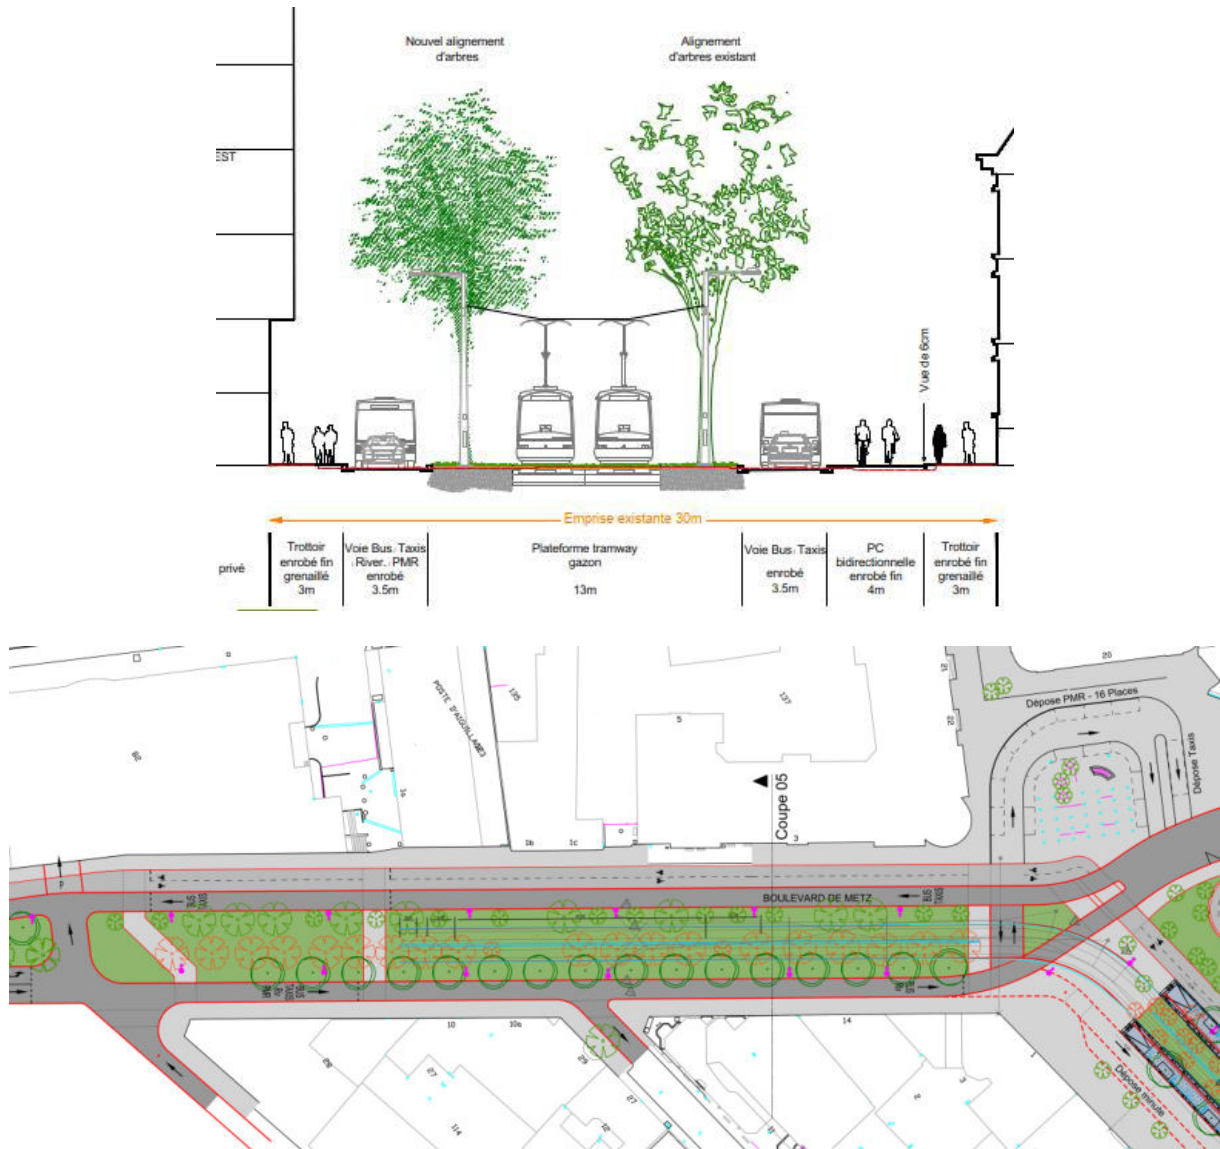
COUPE ET VUE EN PLAN DU BOULEVARD DE METZ
